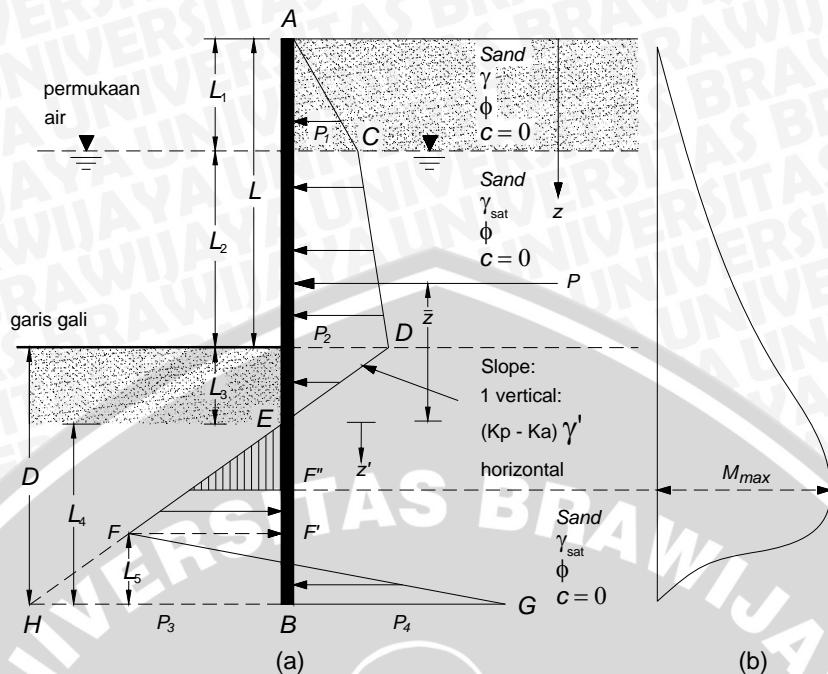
Tekanan tanah pada *cantilever sheet pile
